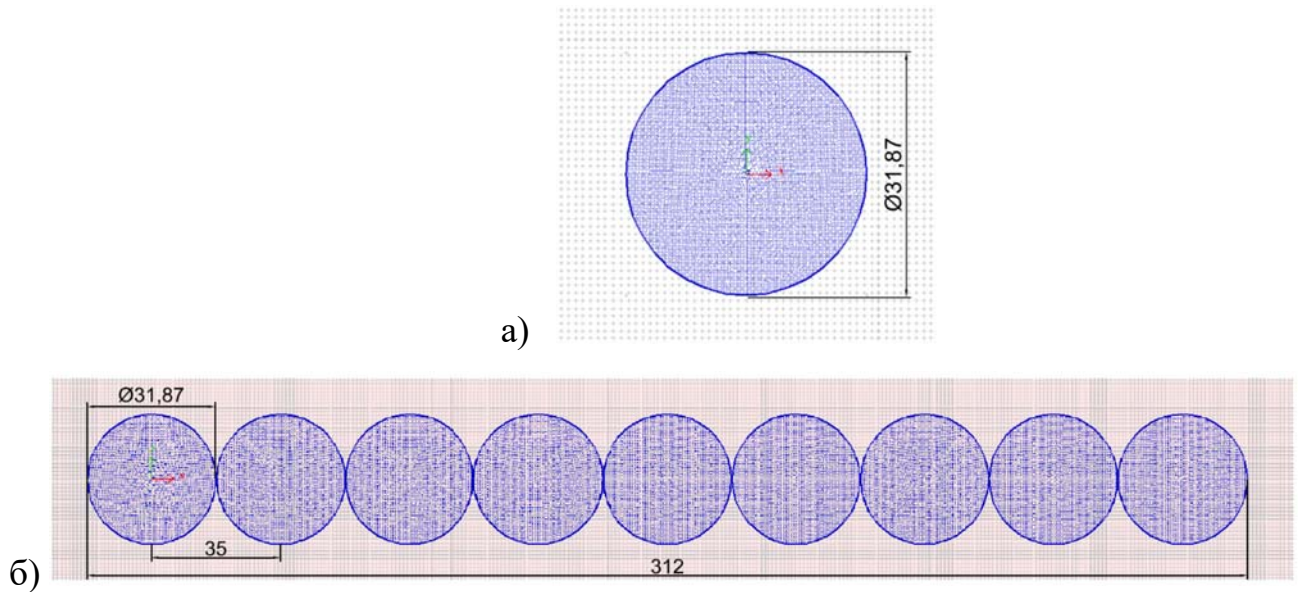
Розрахункова схема фундаментів на ґрунтовій основі для окремого силосу (а) та комплексу з 9 силосів з однорядним розміщенням (б)
